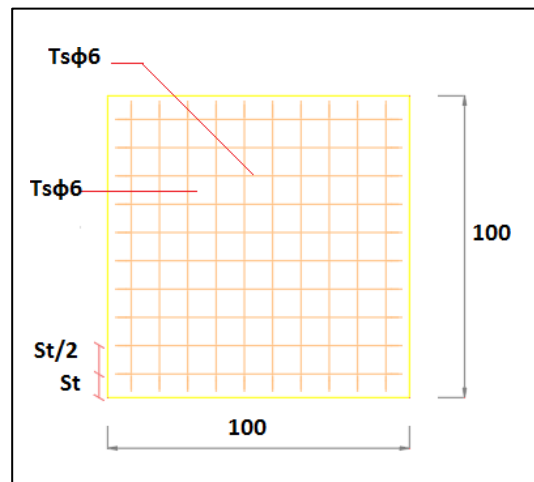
Disposition constructive des armatures de la dalle de compression
